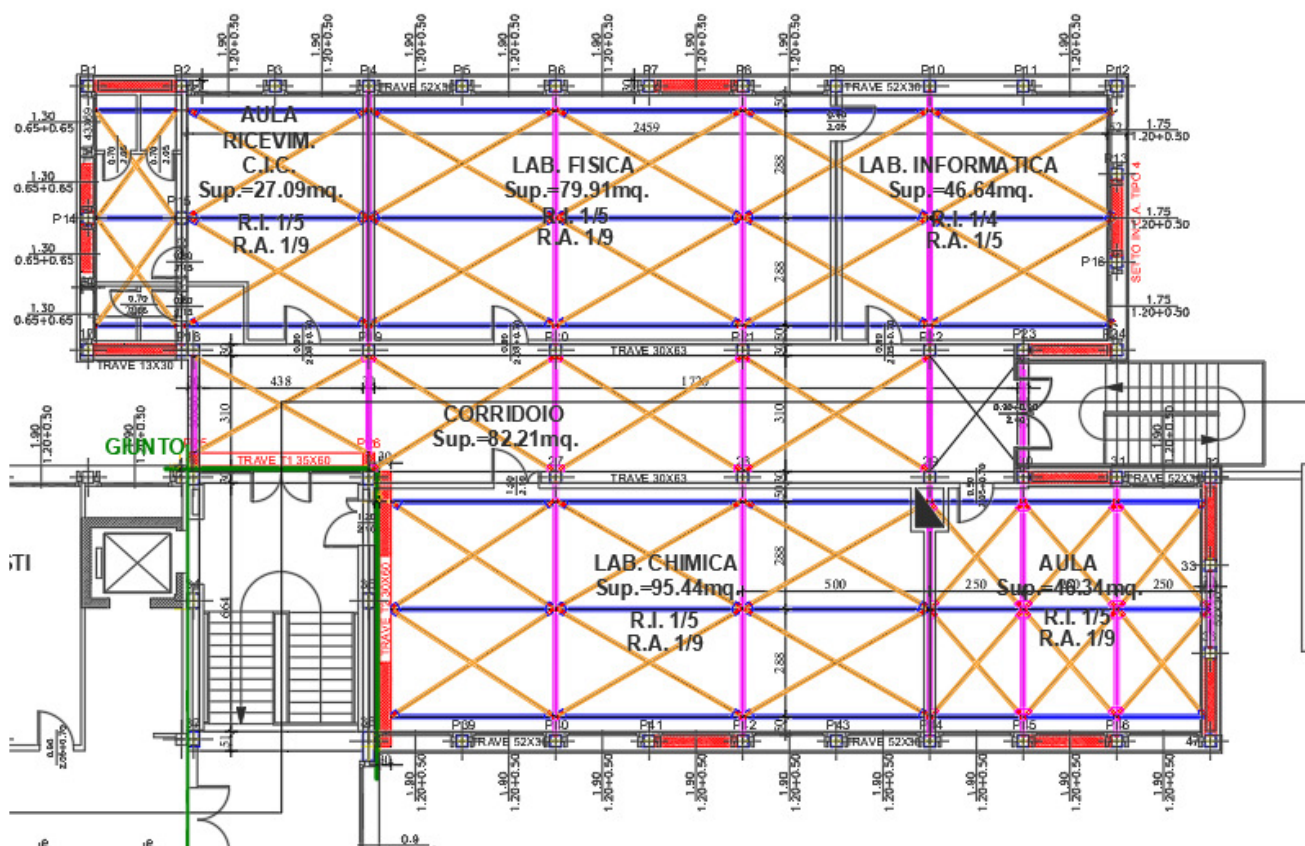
Lavori strutturali LOTTO 1 – piano secondo
